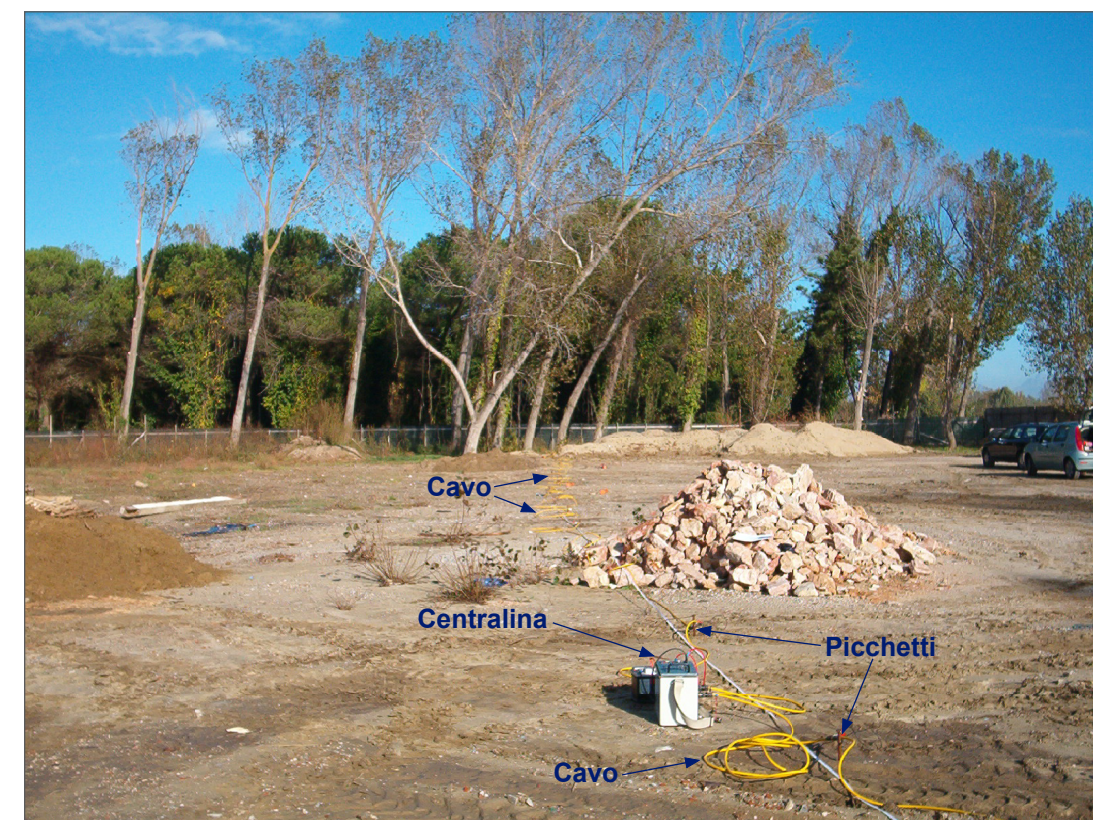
Particolare dello stendimento (St.n°1) per l'esecuzione di tomografia elettrica (indagine geoelettrica) lungo la direzione SSO-NNE, vista da SSO. In primo piano si nota la centralina di induzione della corrente e rilevamento dati.
